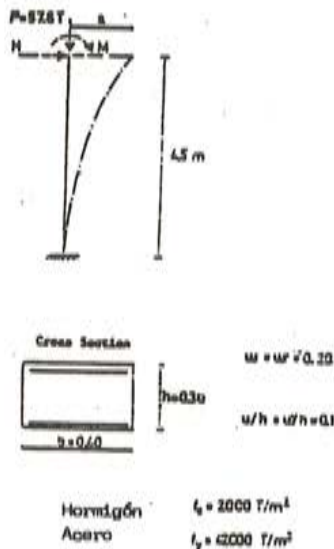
Ejemplo núm. 1. Columna en voladizo
